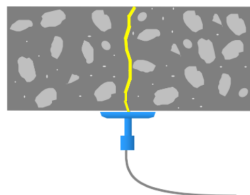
Croqui de regularização da parede e injeção de epóxi na trinca
